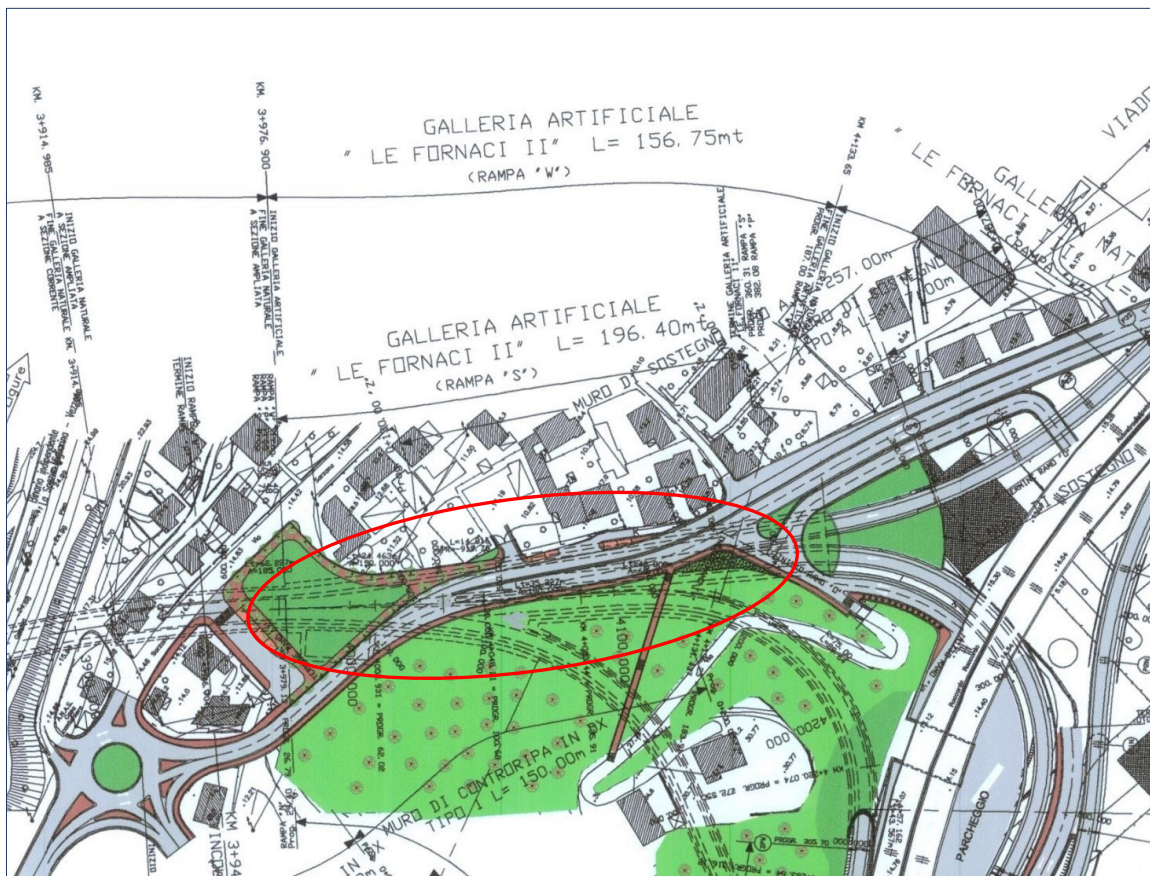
Galleria artificiale Fornaci II – Ubicazione planimetrica
